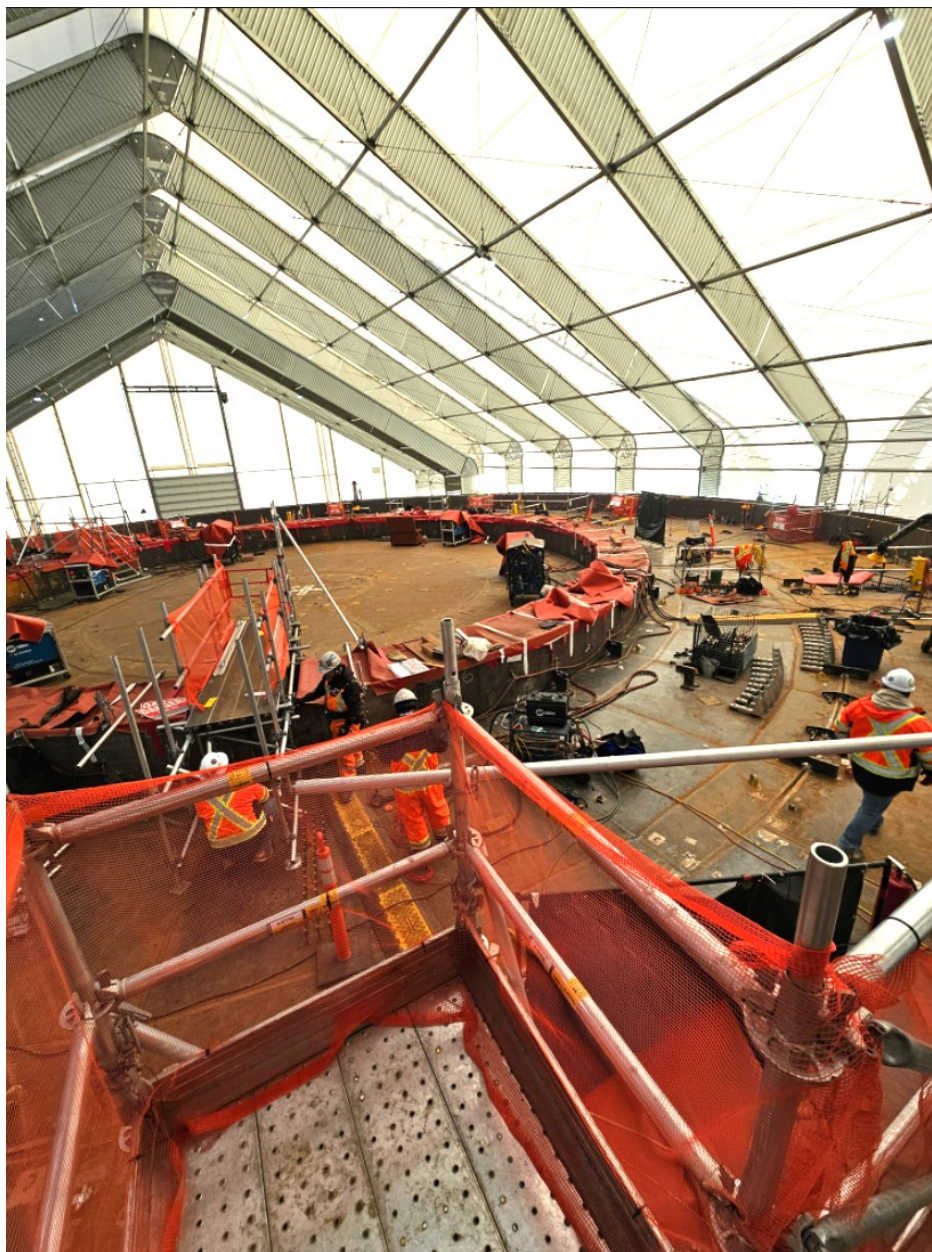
Assemblage des dalles de fondation du bâtiment du réacteur dans le bâtiment de préassemblage, vue en plongée (source : personnel de la CCSN, février 2026)
